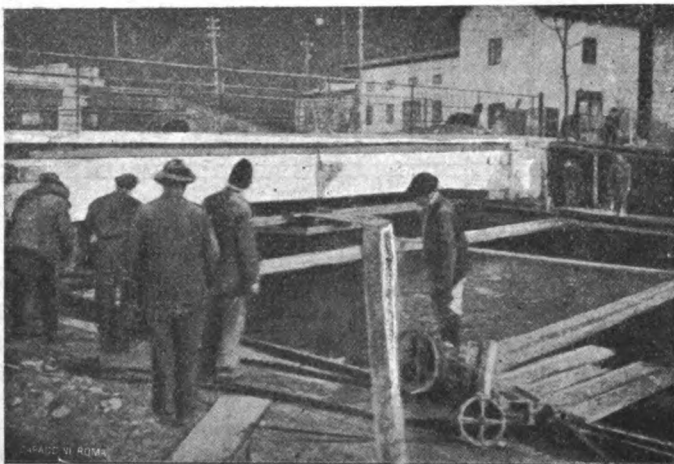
Spostamento di un ponte in cemento armato. - Vista
